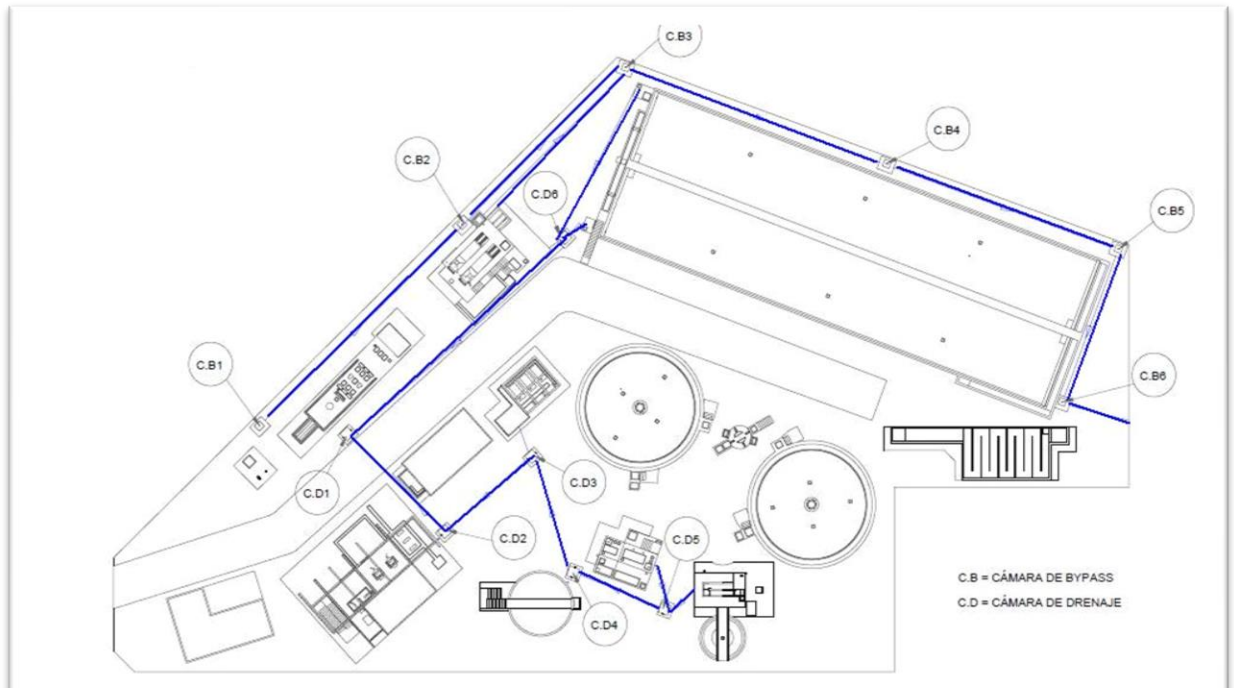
Vista de planta del proyecto de saneamiento hidráulico de la planta. Fuente OPISU.
